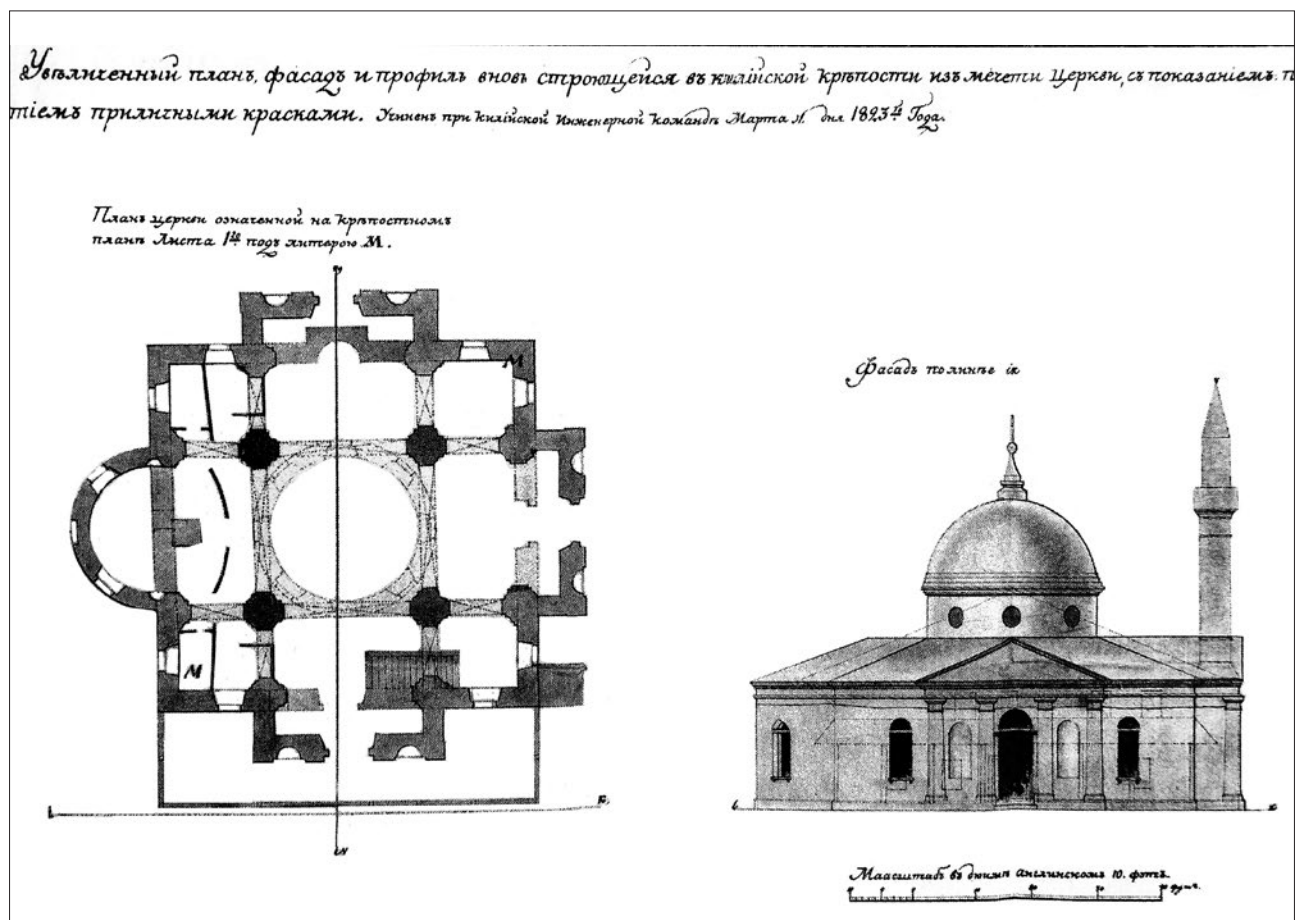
Мечеть Баязида II у Кілії після перетворення на церкву (1823 р.). План і фасад (Şlarac 2016, р. 241).
